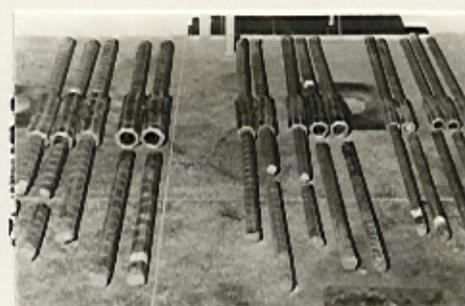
Barras Emendadas com Luvas Prensadas, após Ensaçadas
